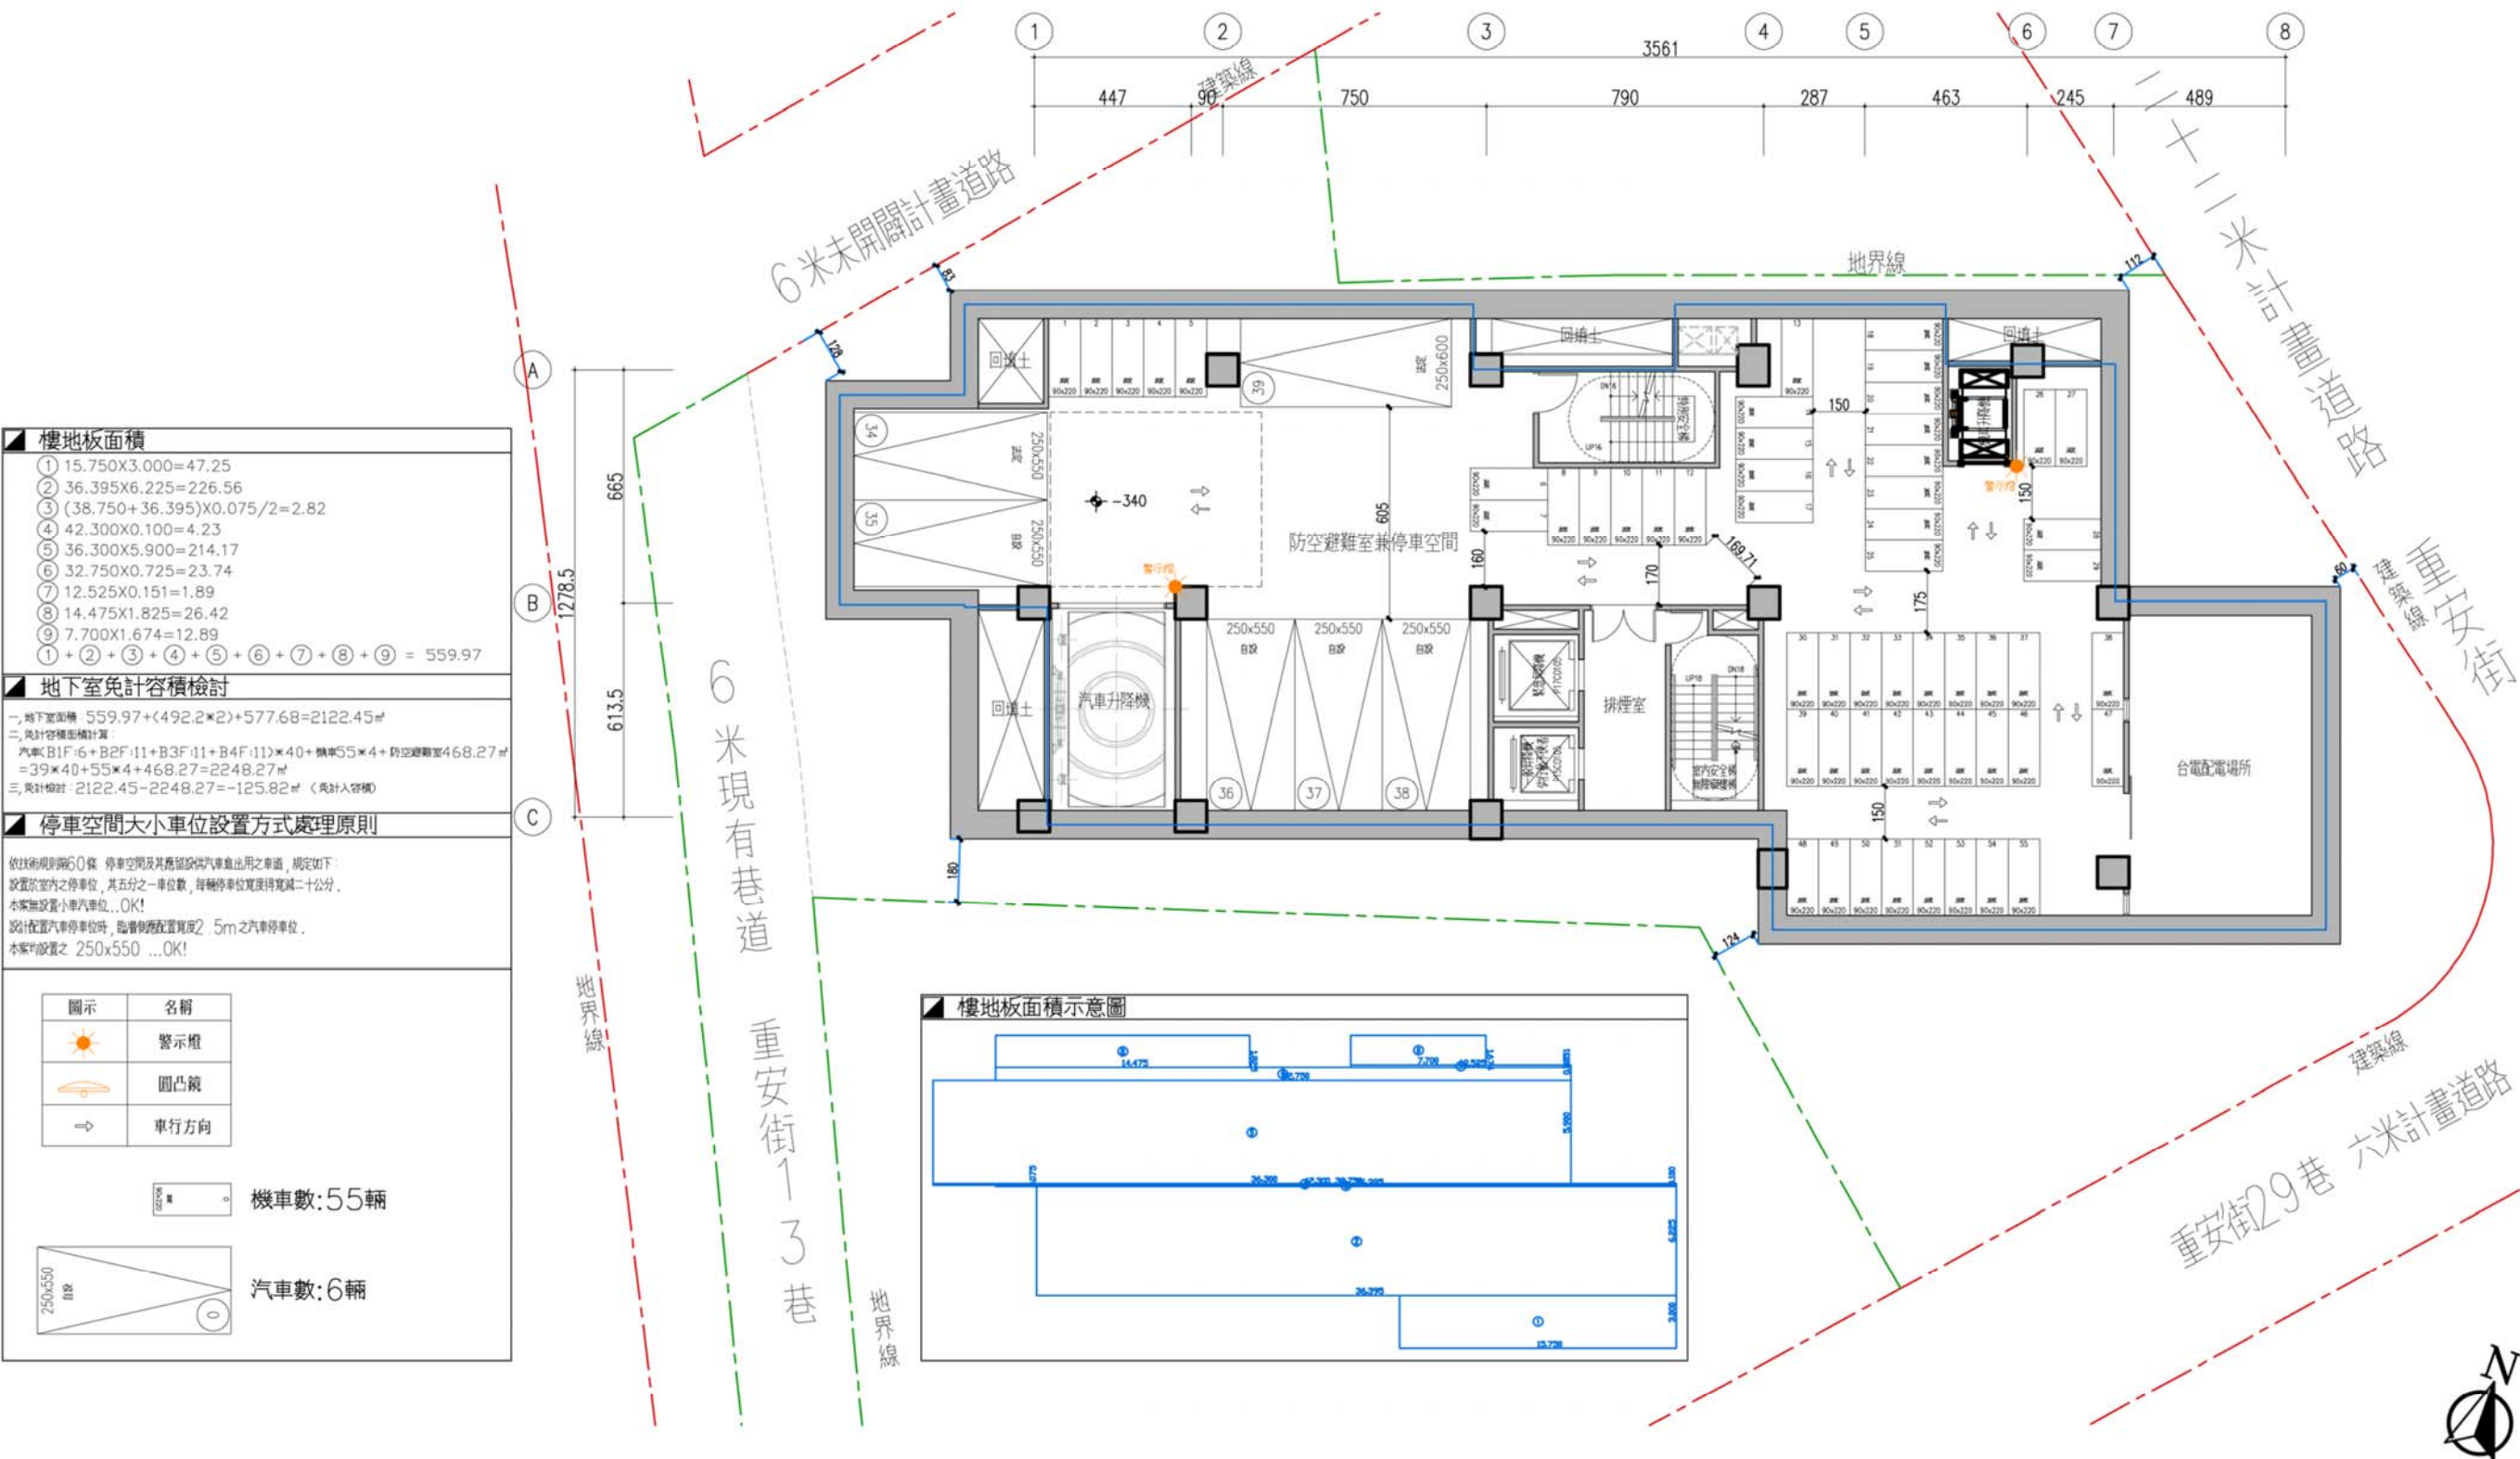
地下一層平面及面積計算圖(S=1/200)
